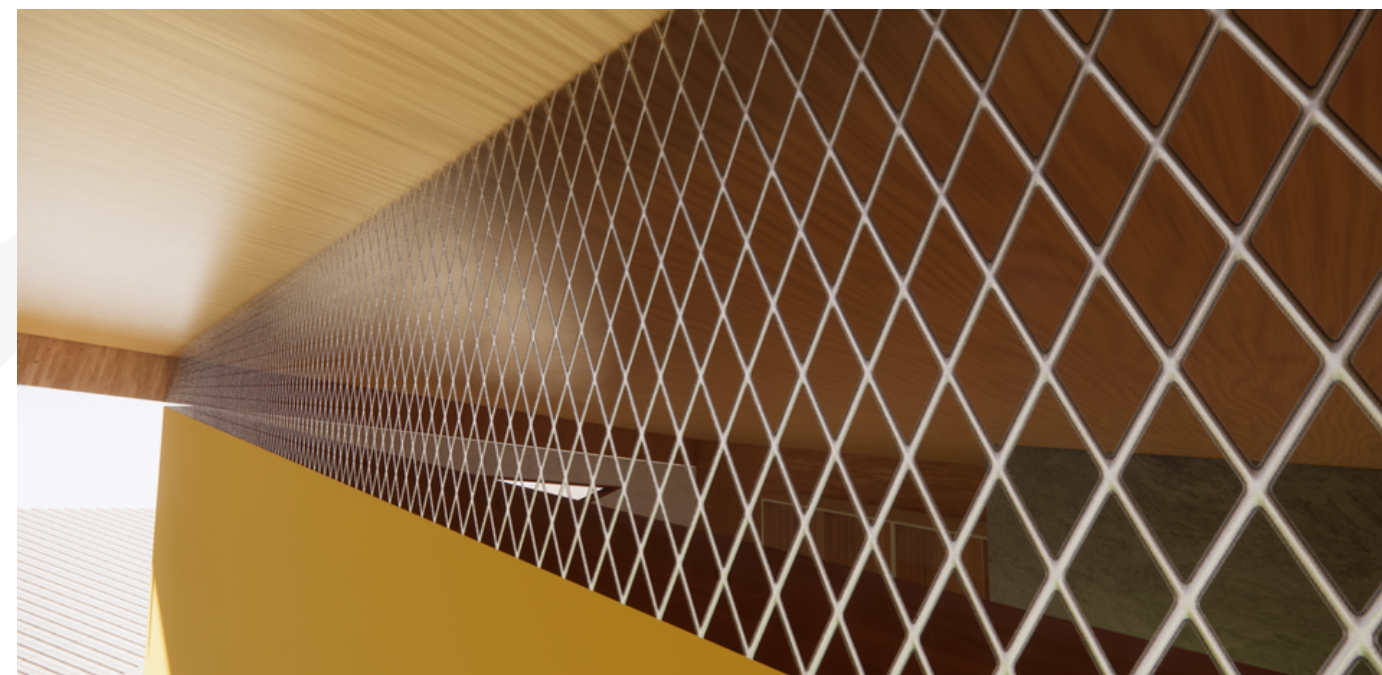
Perspectiva externa do projeto destacando a tela de metálica. Fonte: Elaboração própria da autora.
